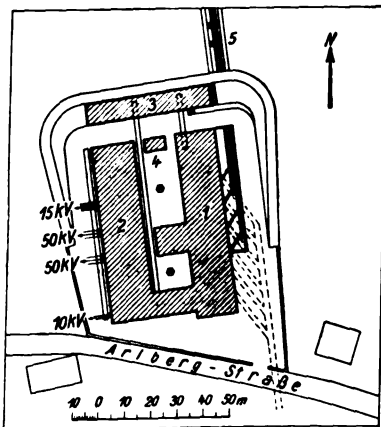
Lageplan des Spullerseewerkes in Danöfen.
